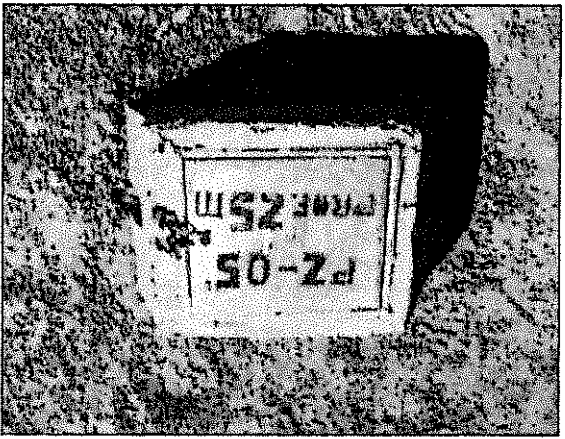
Instalación de Piezómetro PZ - 05, ubicado de la parte baja de las Pozas Raff.
